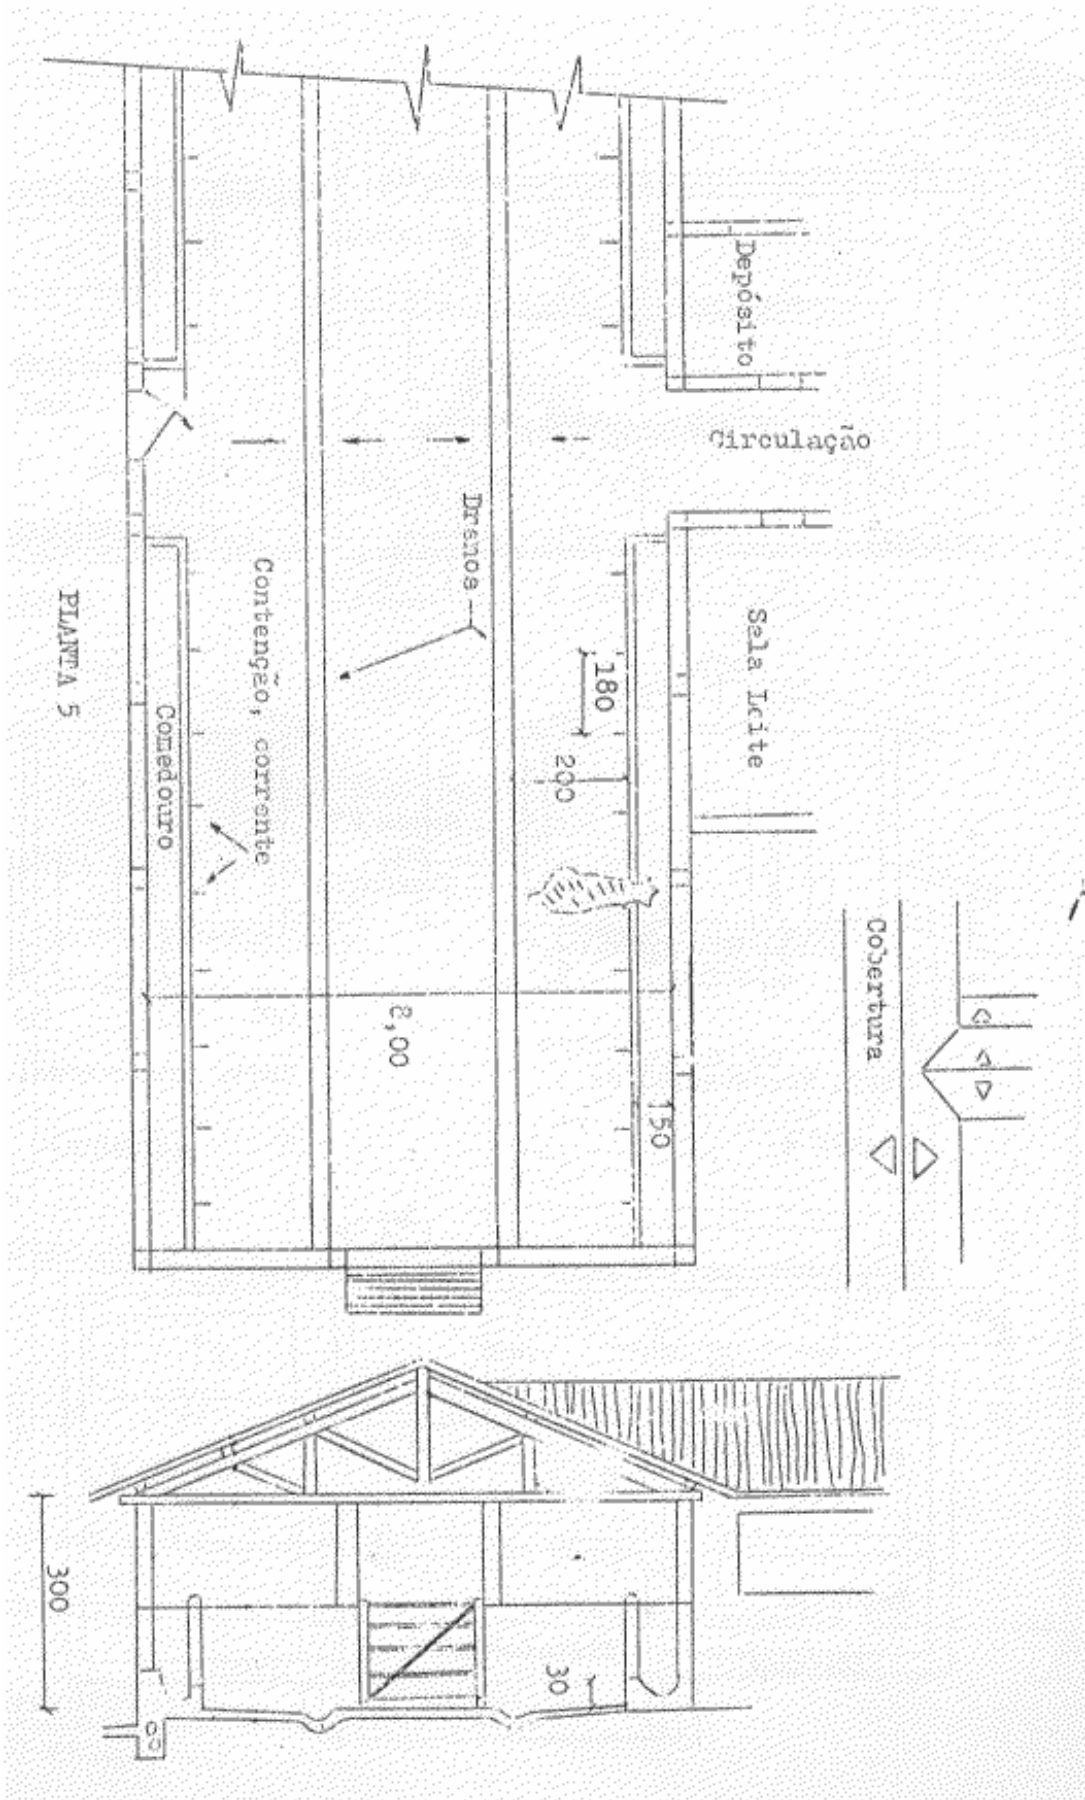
Detalhes da Construção da Sala de Ordenha
